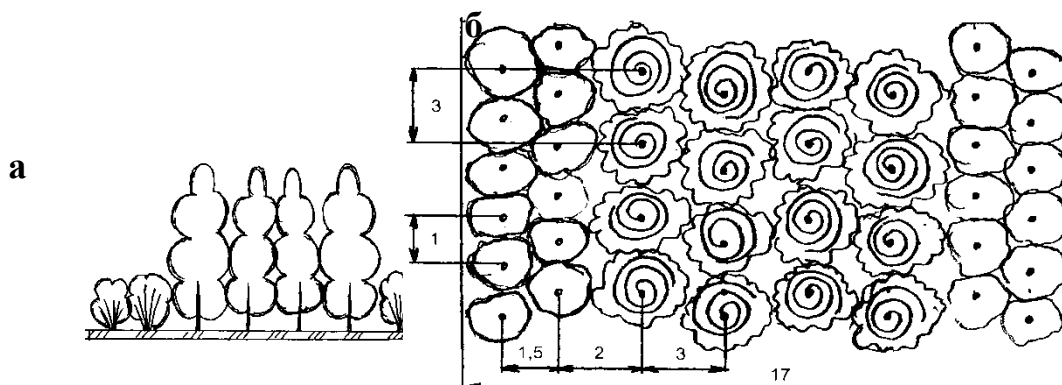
Схема размещения растительности в противоабразионной лесополосе среднего берегового пояса: а – в разрезе, б – на плане
